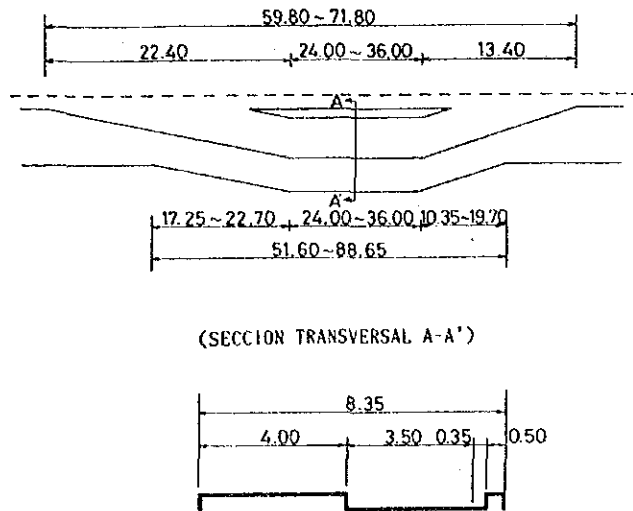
SECCION TRANSVERSAL ESTANDAR DE LA BAHIA PARA BUSES
